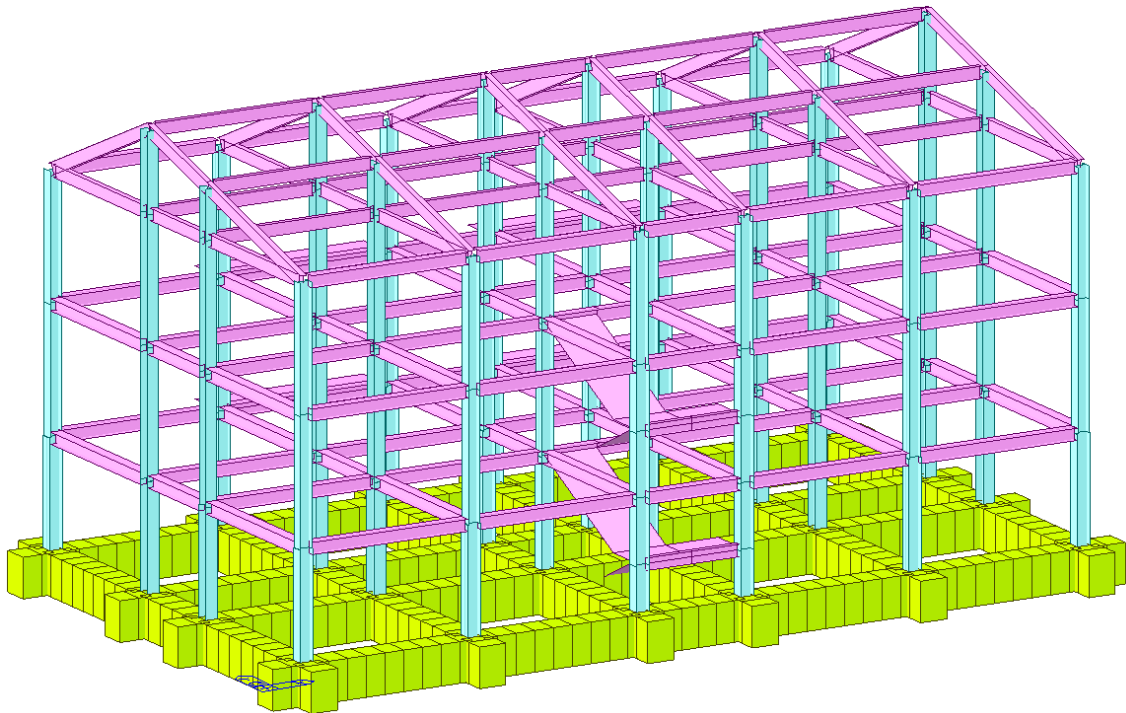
Modello FEM edificio a tre piani in acciaio con trave rovescia - Vista assonometrica 1.
